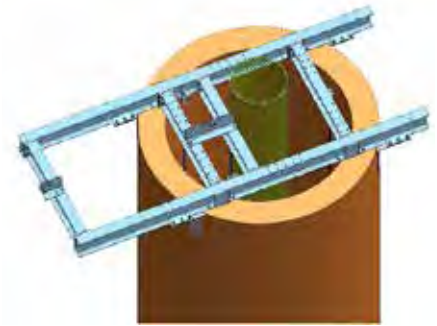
Stahlträger-Konstruktion an der Mündung für Abbruch
